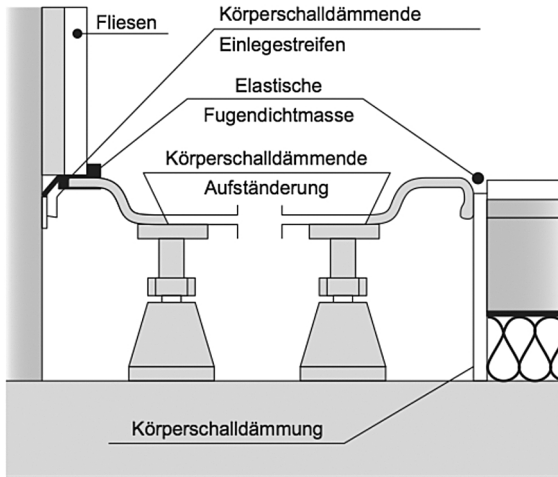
Montagedetail Einbau einer Duschwanne.
